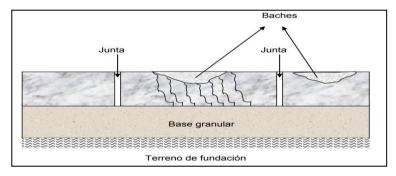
Falla por rotura o bacheo de Pavimento Rígido
